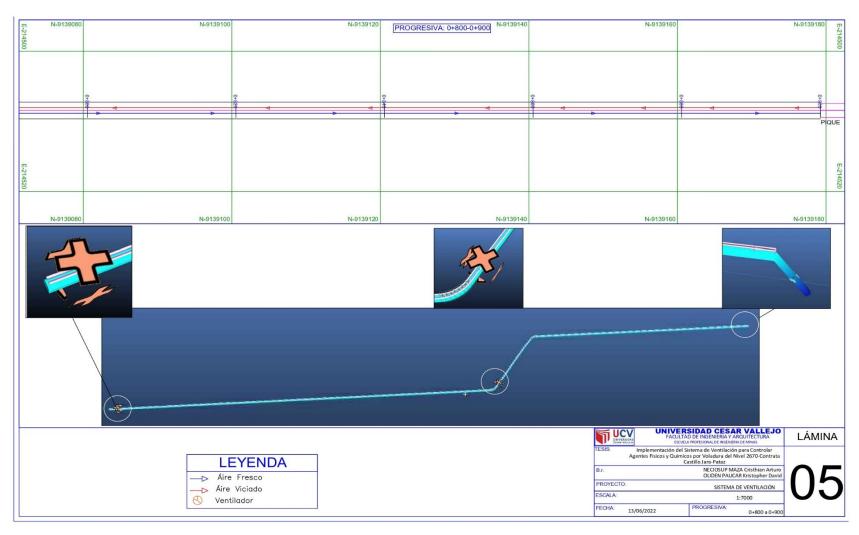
Plano en autocad del nivel 2670 – Progresiva 800-918 y Plano de ventsim.
